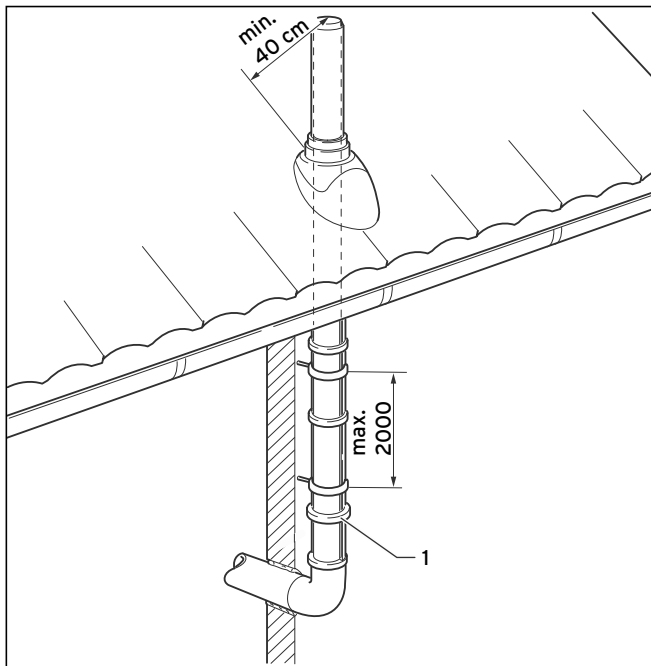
Монтаж выпускного газопровода на наружном фасаде
